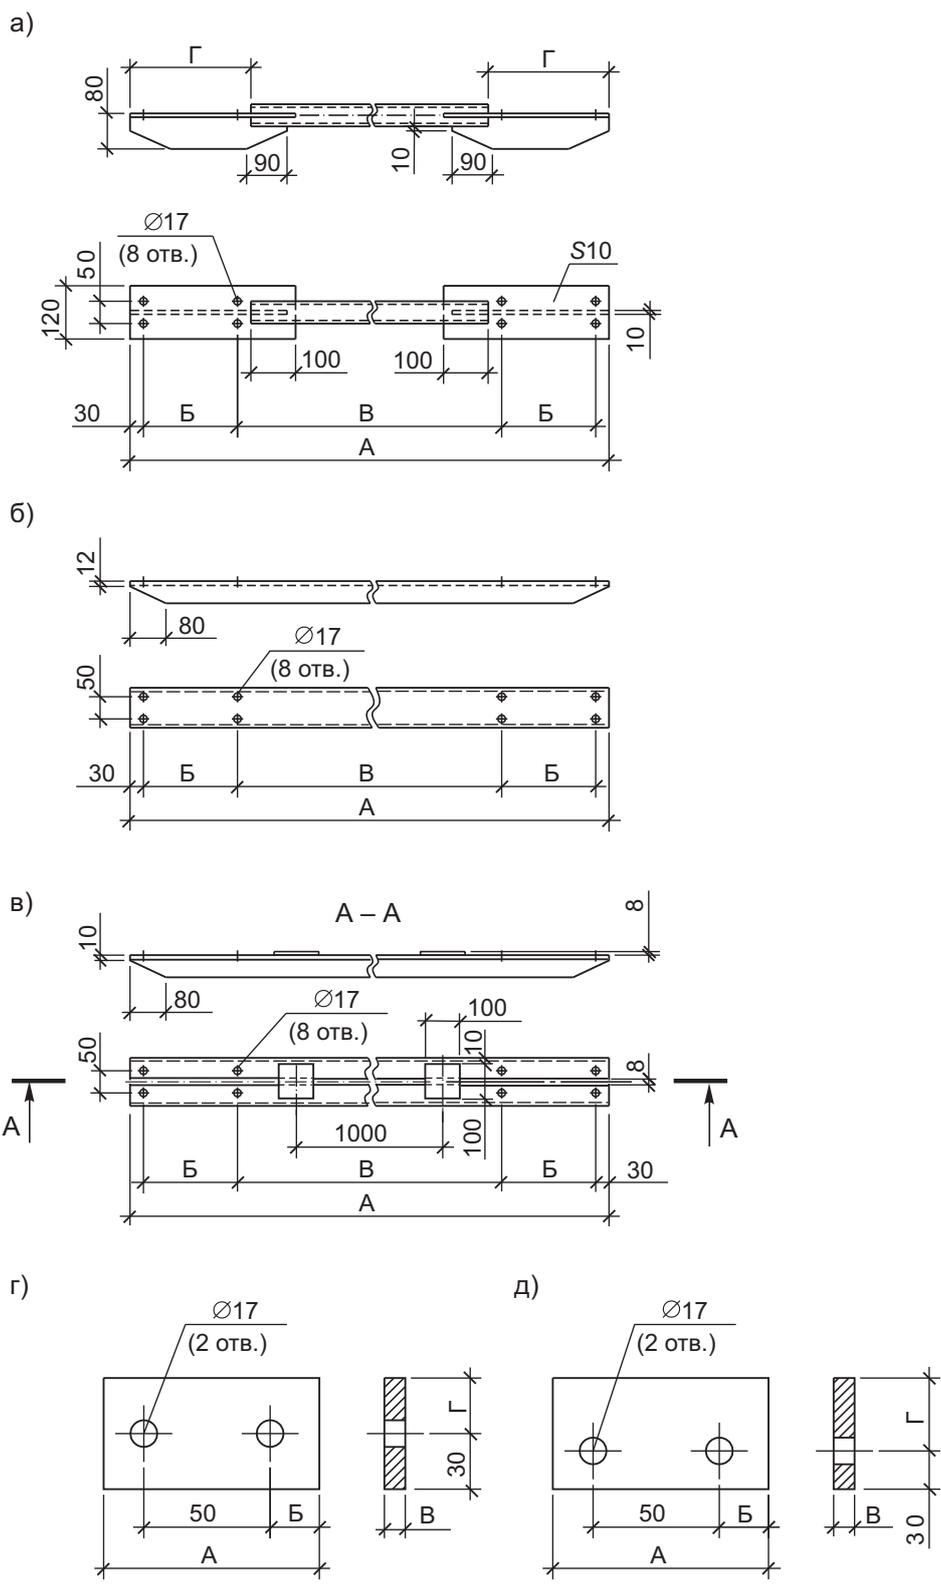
Стяжки и детали крепления стяжек к рельсам путей с деревянными полушпалами:
